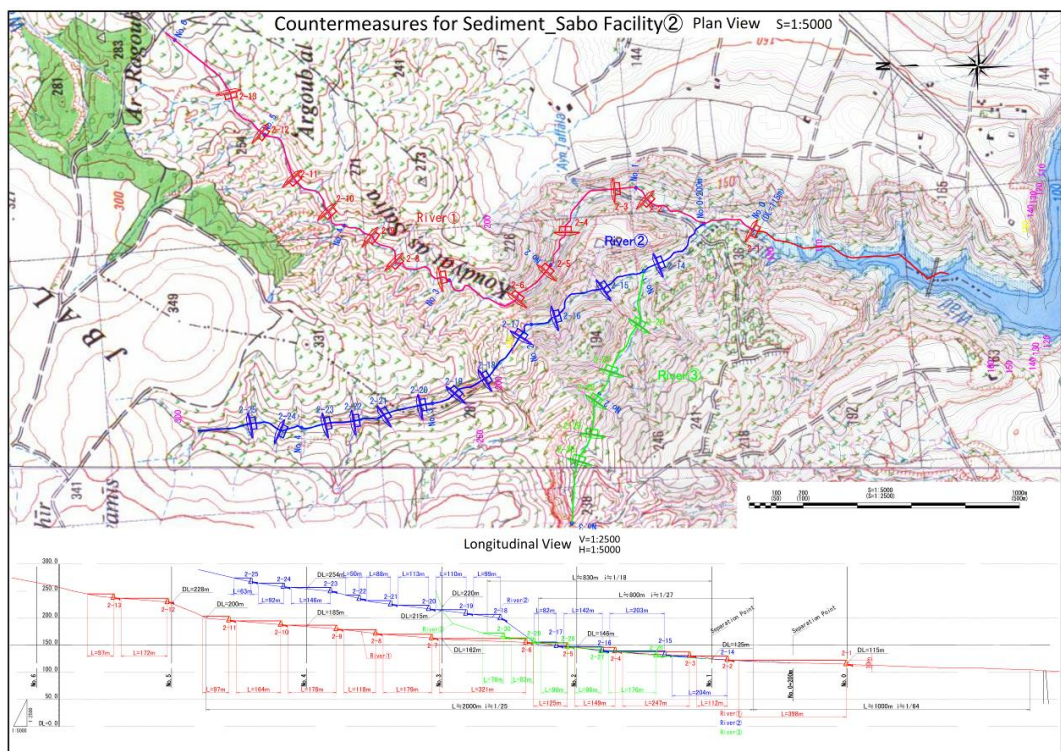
Plan d'aménagement des installations de barrages de contrôle (2) Wad Koudyat
